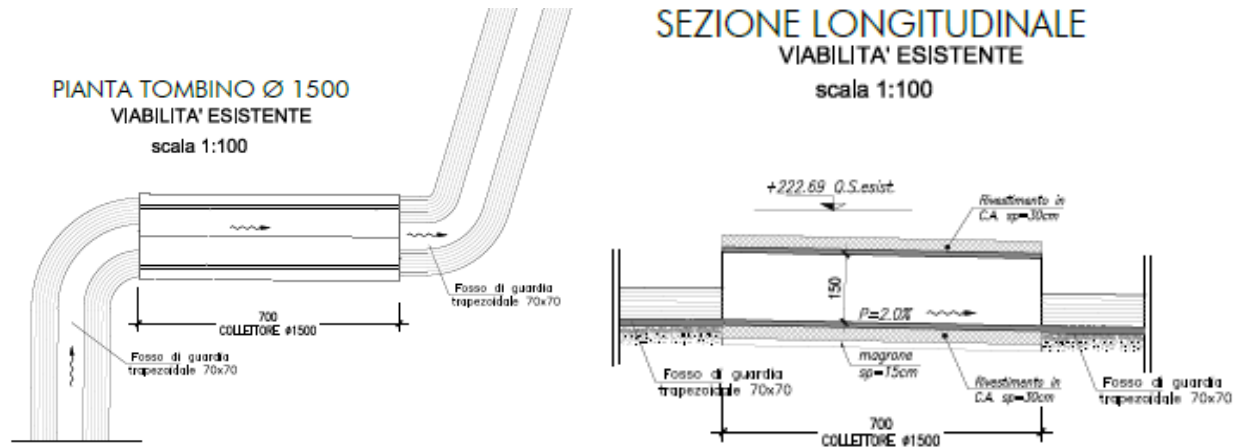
Planimetria e sezione longitudinale tombino sotto viabilità esistente
